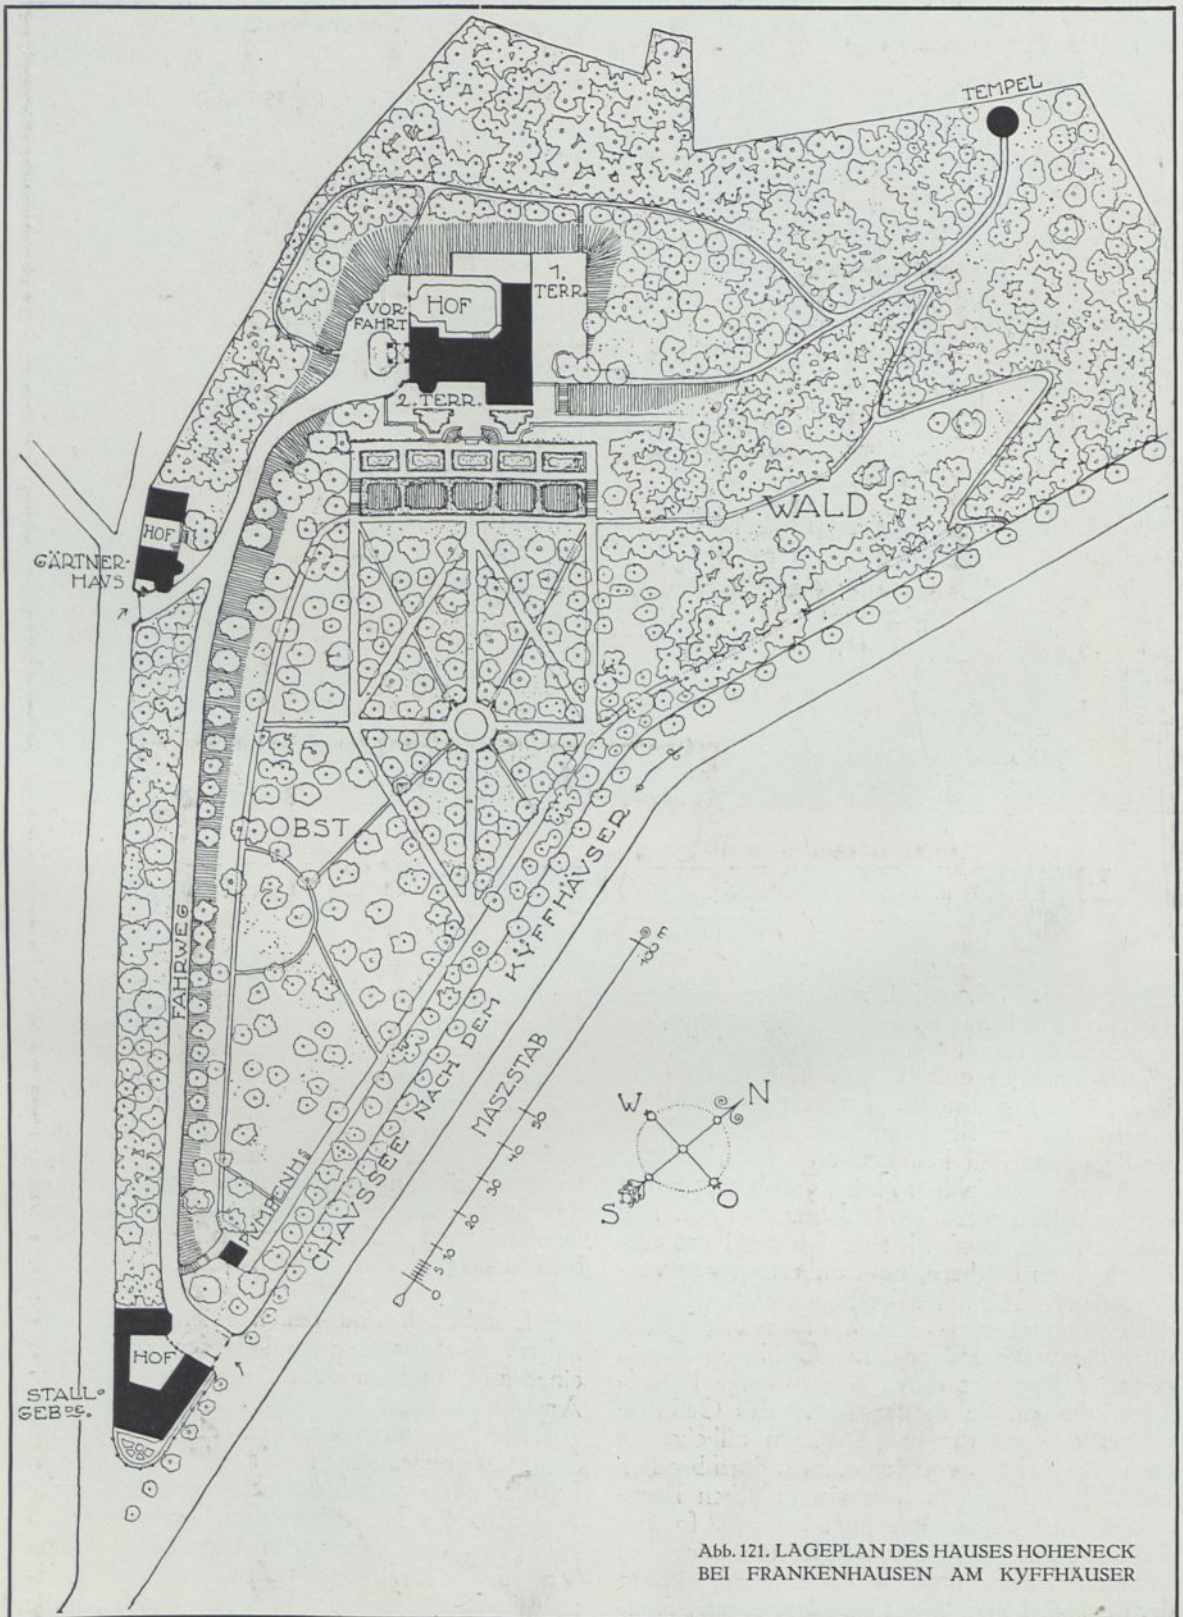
LAGEPLAN DES HAUSES HOHENECK BEI FRANKENHAUSEN AM KYFFHAUSER
